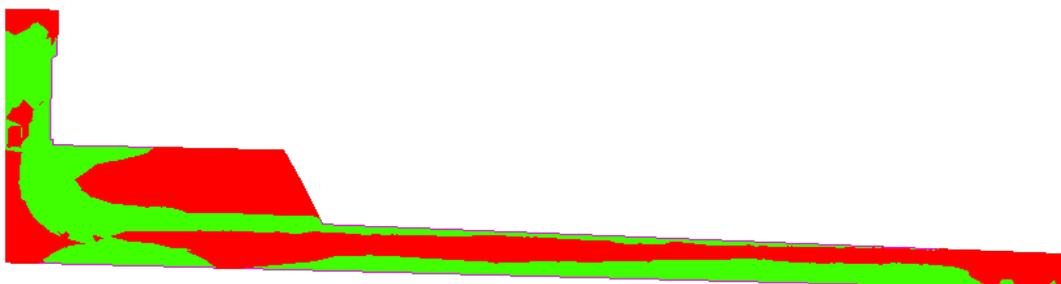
f: Planimetria Scavo di Livellamento Area Sud Impianto
